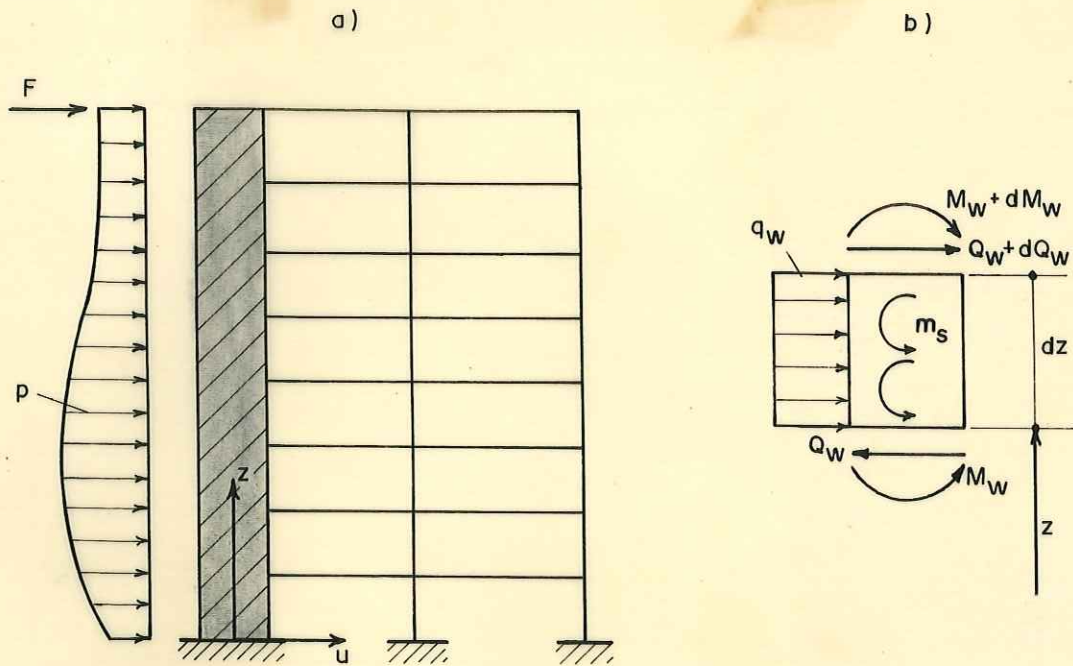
PAREDE E PÓRTICO LIGADOS POR VIGA
